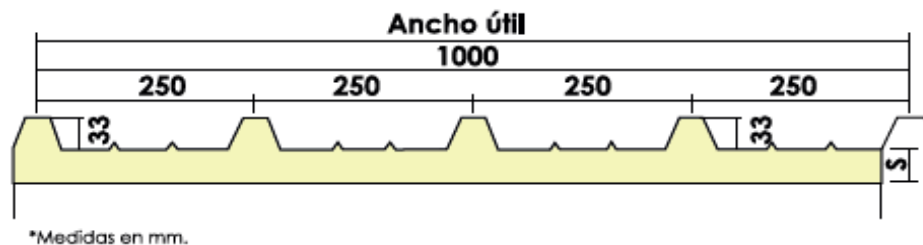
Detalle teja KingRoof ECO, Fuente: KINGSPAN.
